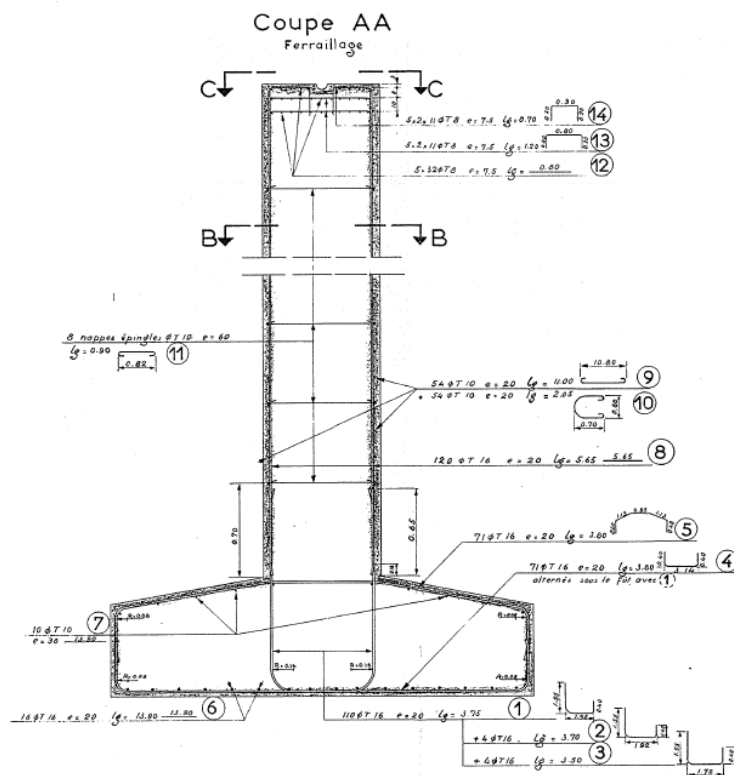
Plan de ferrailage des piles – Coupe transversale
